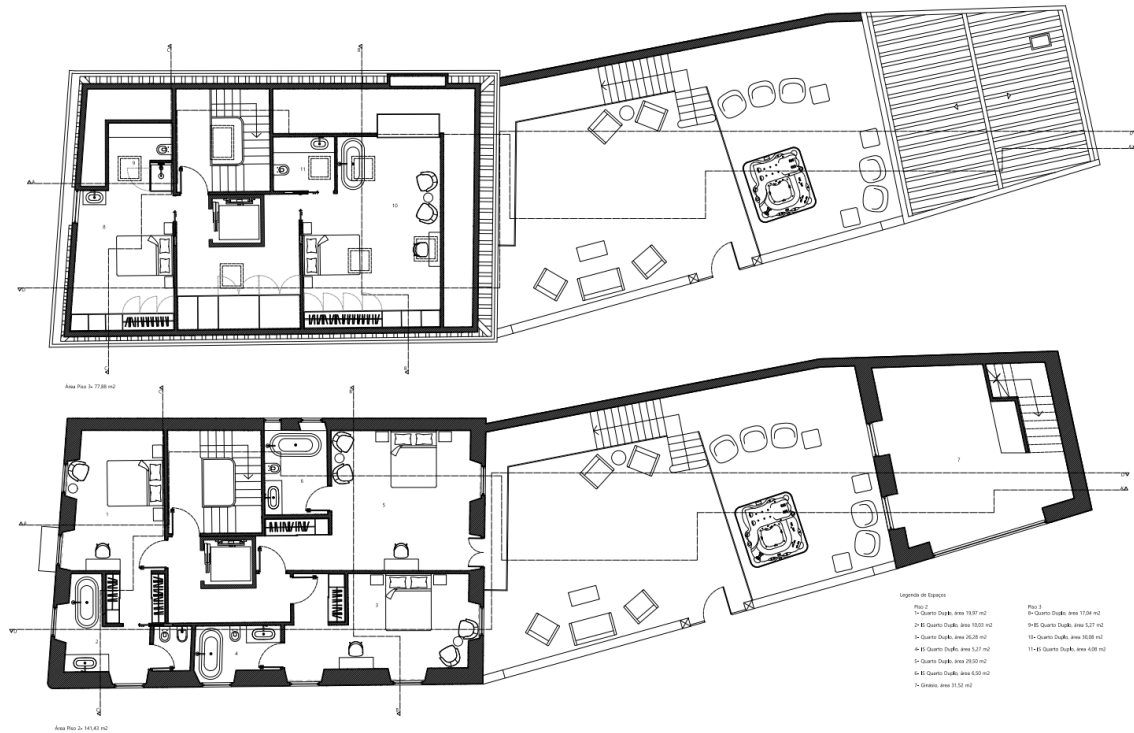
Planta de proposta - Piso 2 e Piso 3
